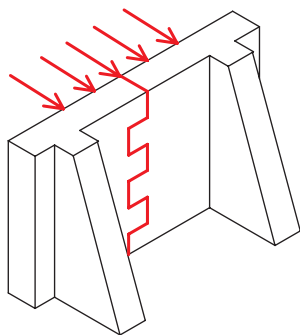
Растяжение кладки при изгибе по перевязанному сечению
